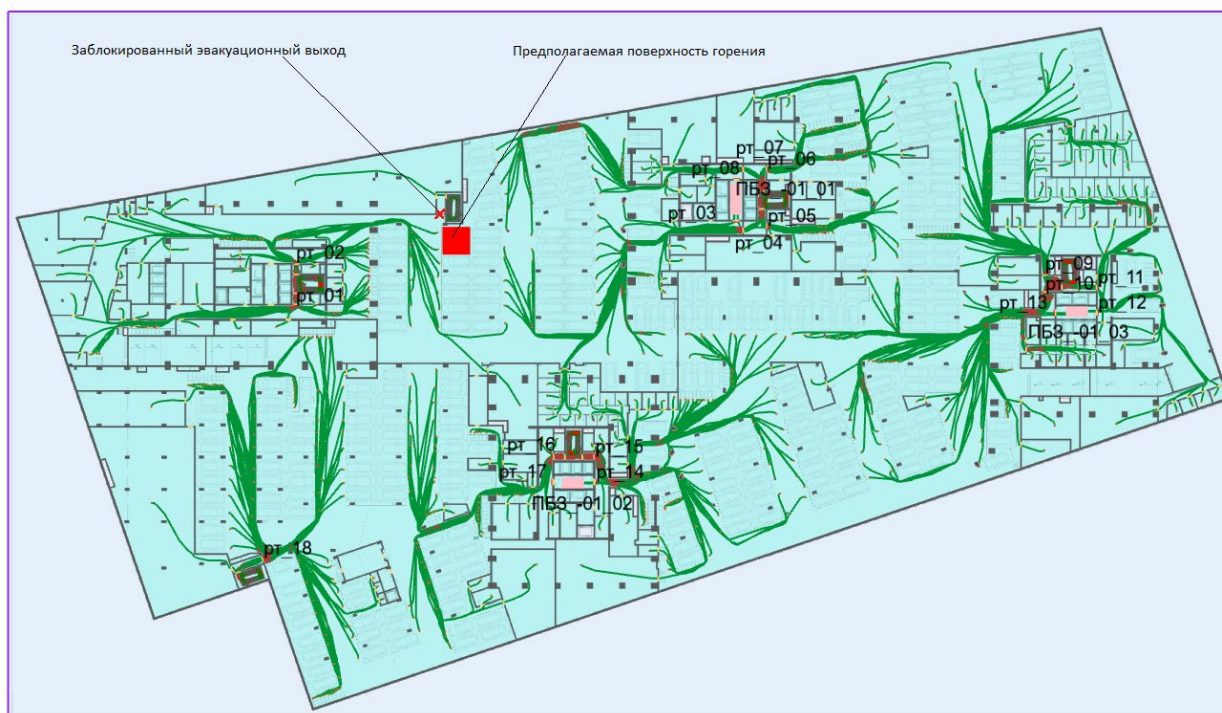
План минус 1-го этажа и нанесенная на него расчетная (принципиальная) схема эвакуации
